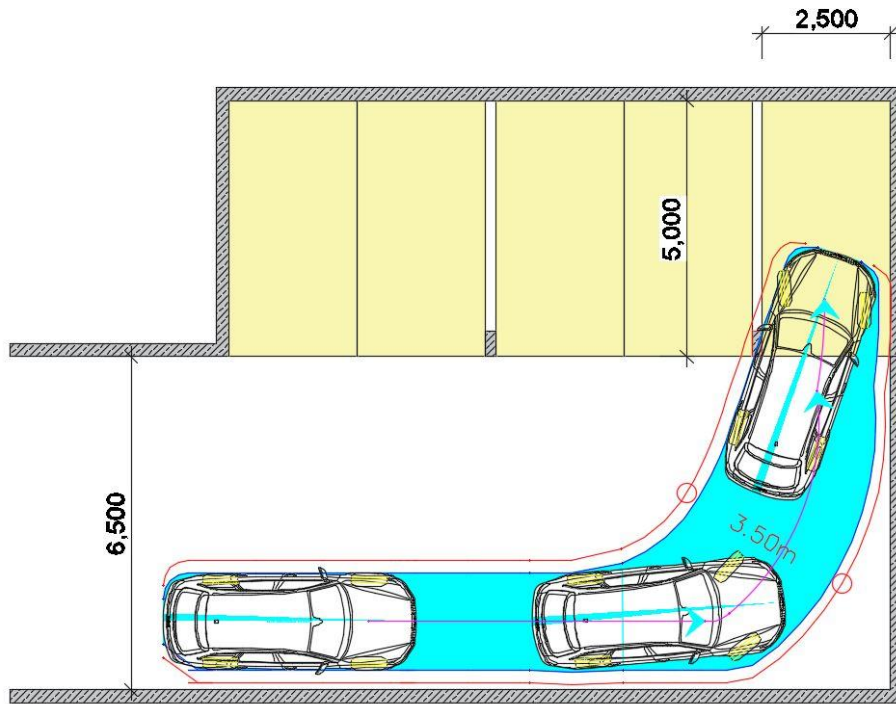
Grundriss mit Mindestabmessungen nach Garagenverordnung - Kollisionen mit den seitlich begrenzenden Bauteilen sind trotz Rangieren kaum vermeidbar; Darstellung beispielhaft mit „Realfahrzeug“ Audi A6 Avant Baujahr 2017
